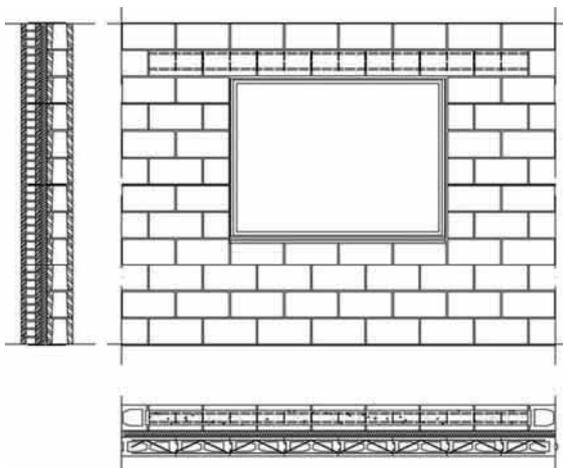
Ventana en muro de 2 hojas de ladrillo alargado y bloque hueco de carga con cercha de tendel: alzados, plantas y secciones.
